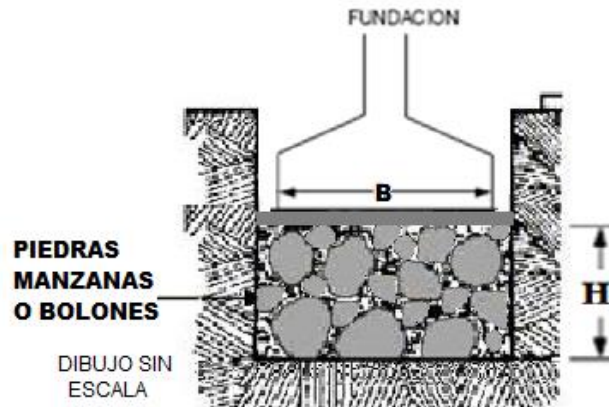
Mejoramiento de suelos con piedras debajo de la zapata
